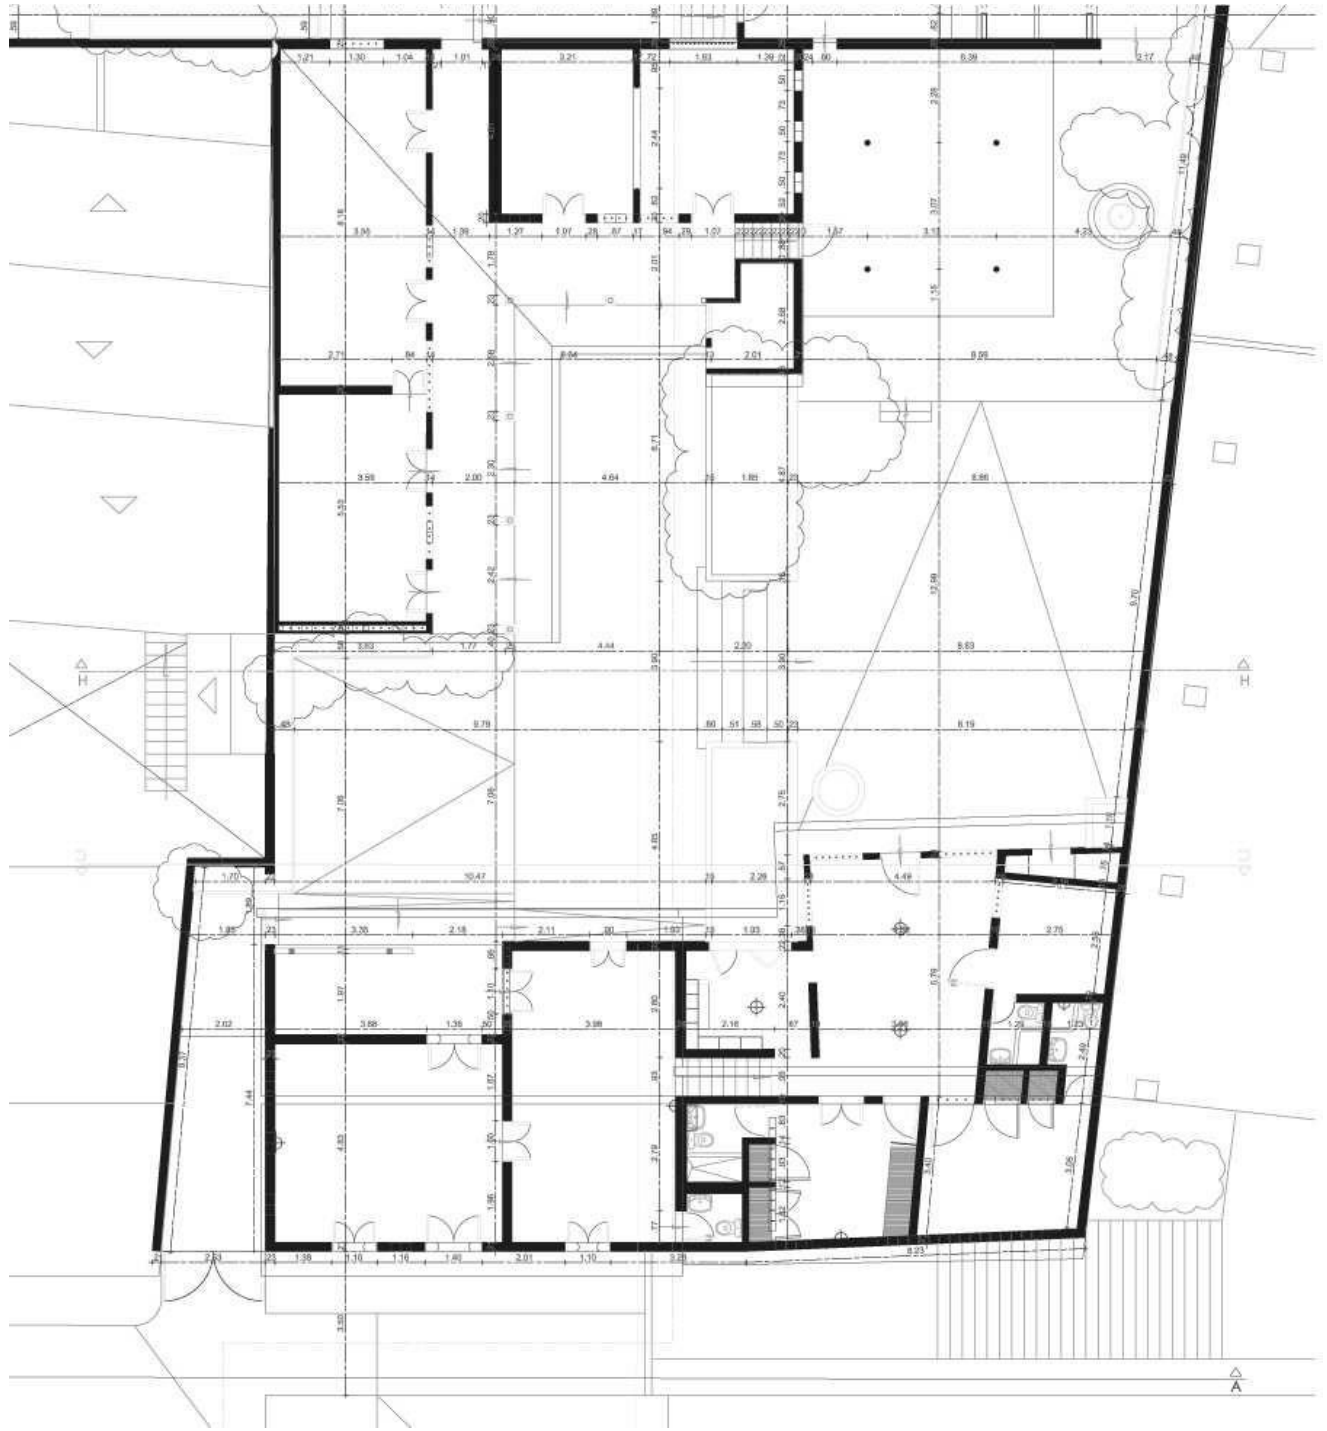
(Planta de levantamiento principal, fuente propia,2018)
